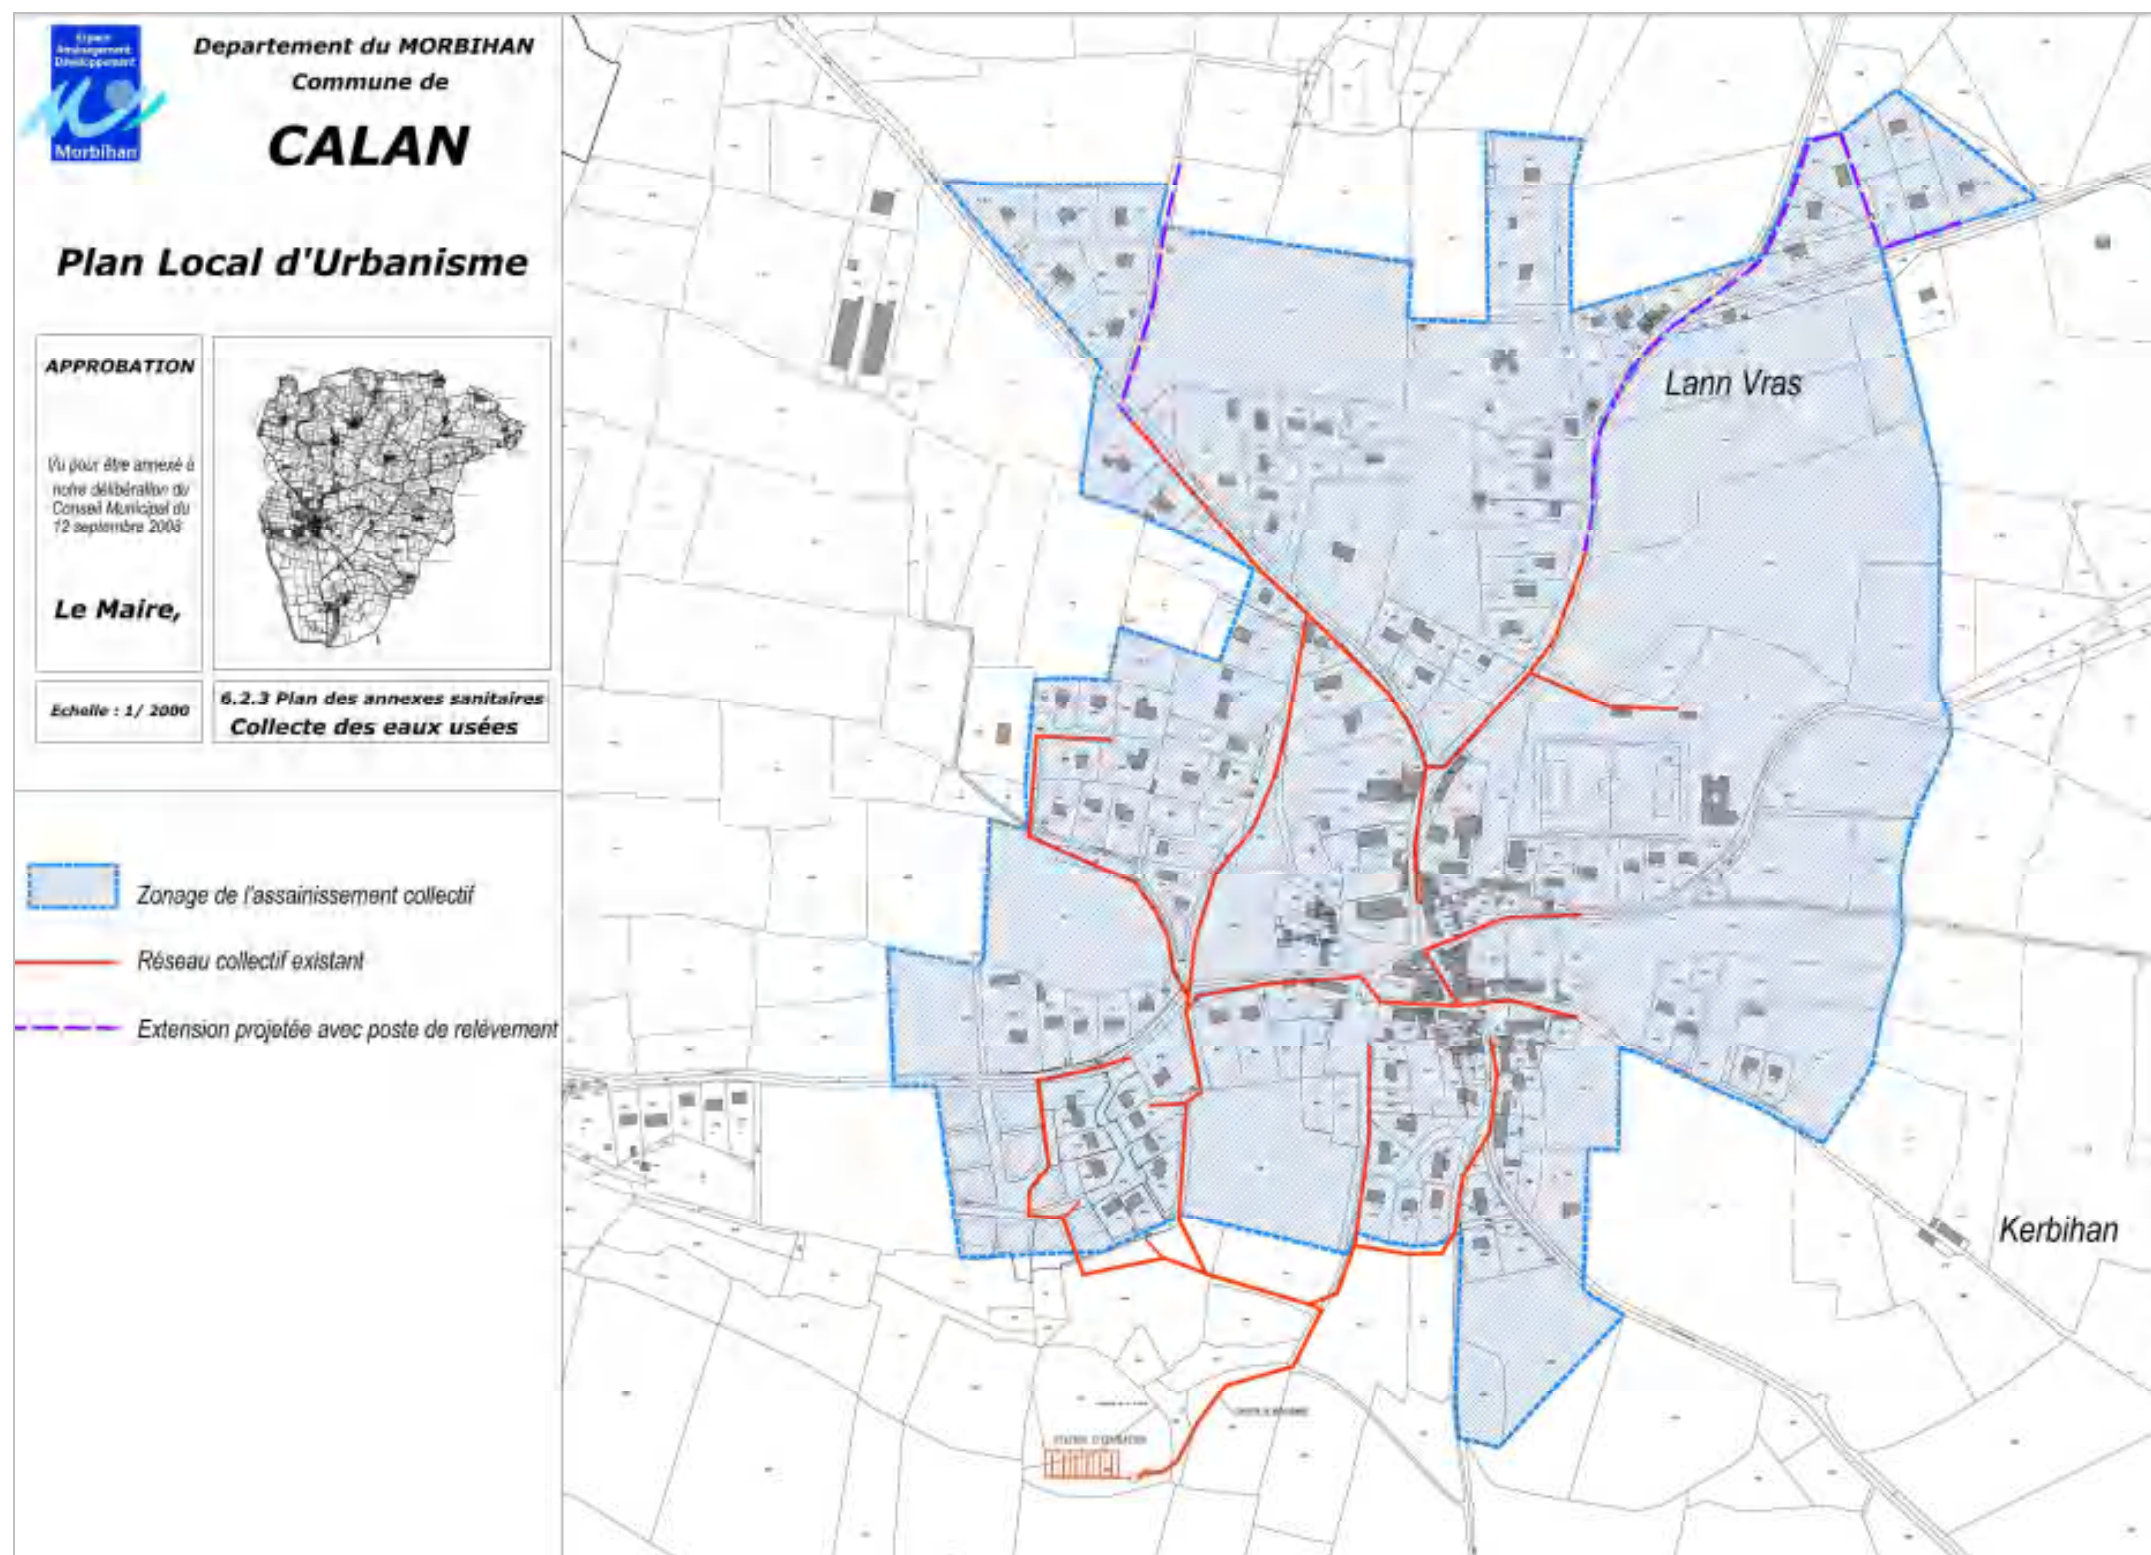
Plan du zonage d'assainissement des eaux usées actuel - 12 septembre 2008
